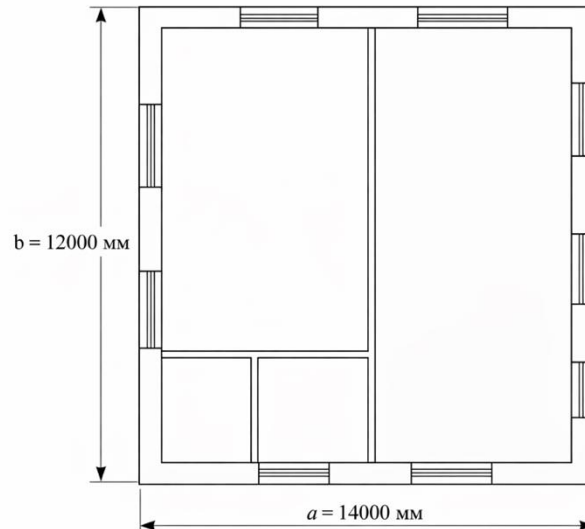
Конструктивні розміри 1 -го поверху
